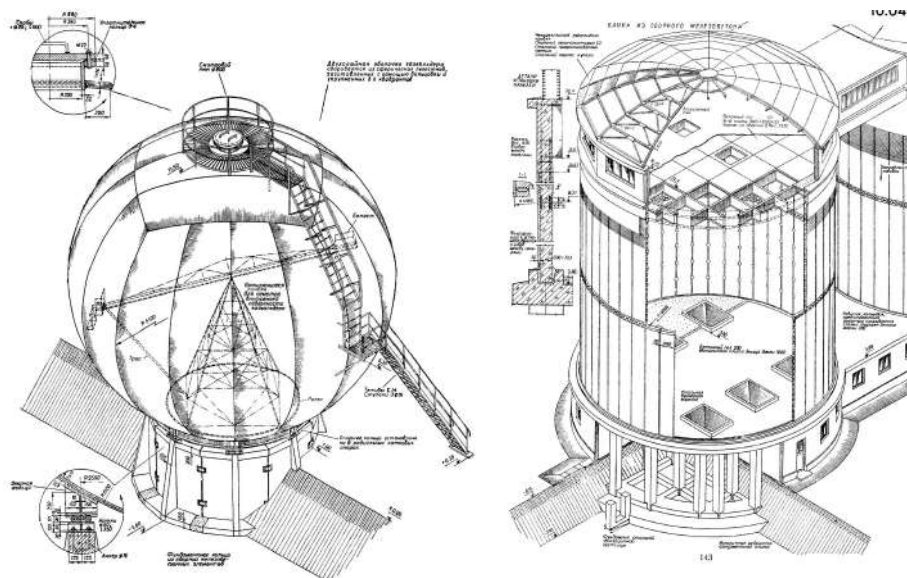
Конструктивна схеми резервуарів. [78]
